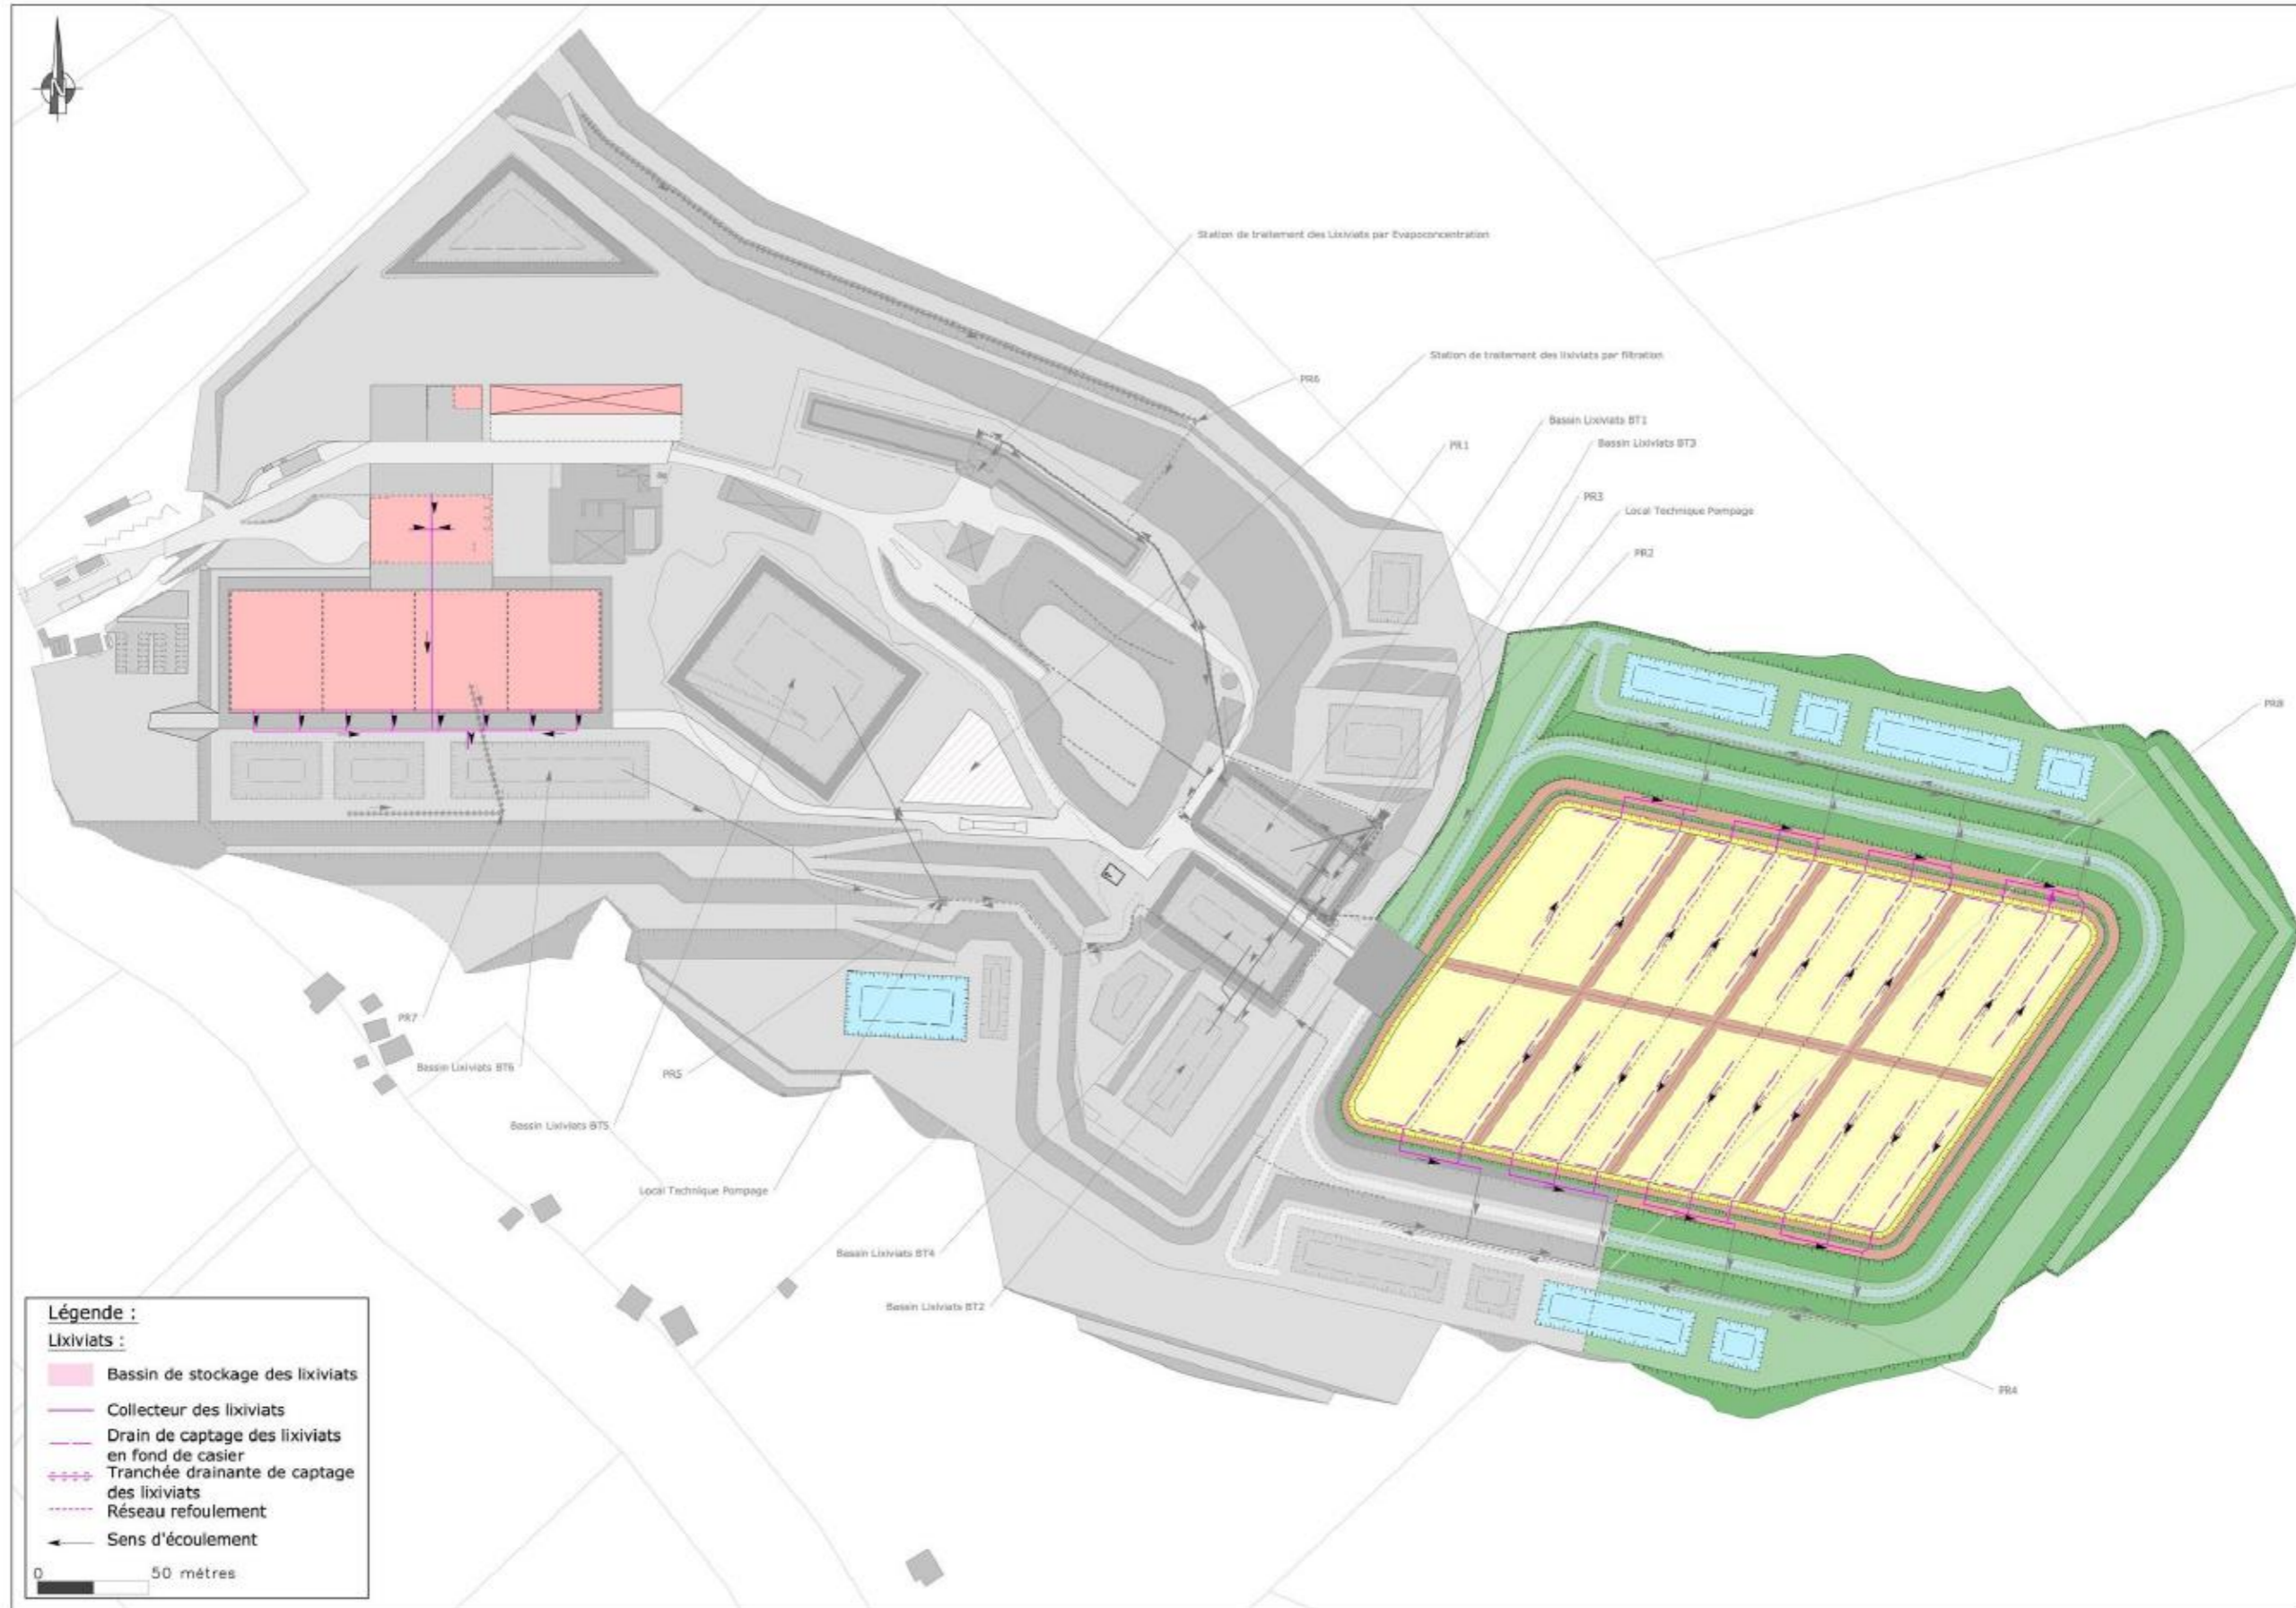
Plan du réseau de collecte des lixiviats niveau 2 (Source : BETA Environnement)
